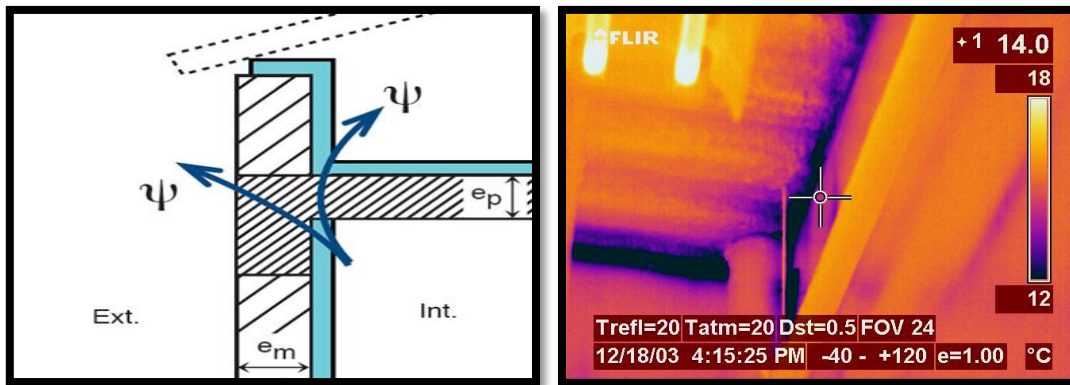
Ligação da Fachada com Cobertura Inclinada ou Terraço; fonte: RCCTE (2006); Finn M. (2004)
